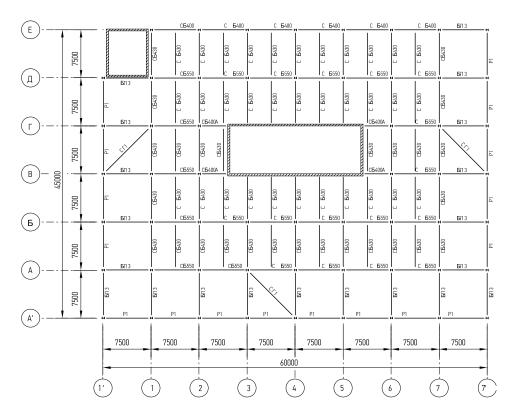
Маркировочный план несущих конструкций перекрытия для короткопролетной схемы стального каркаса на уровне 2
